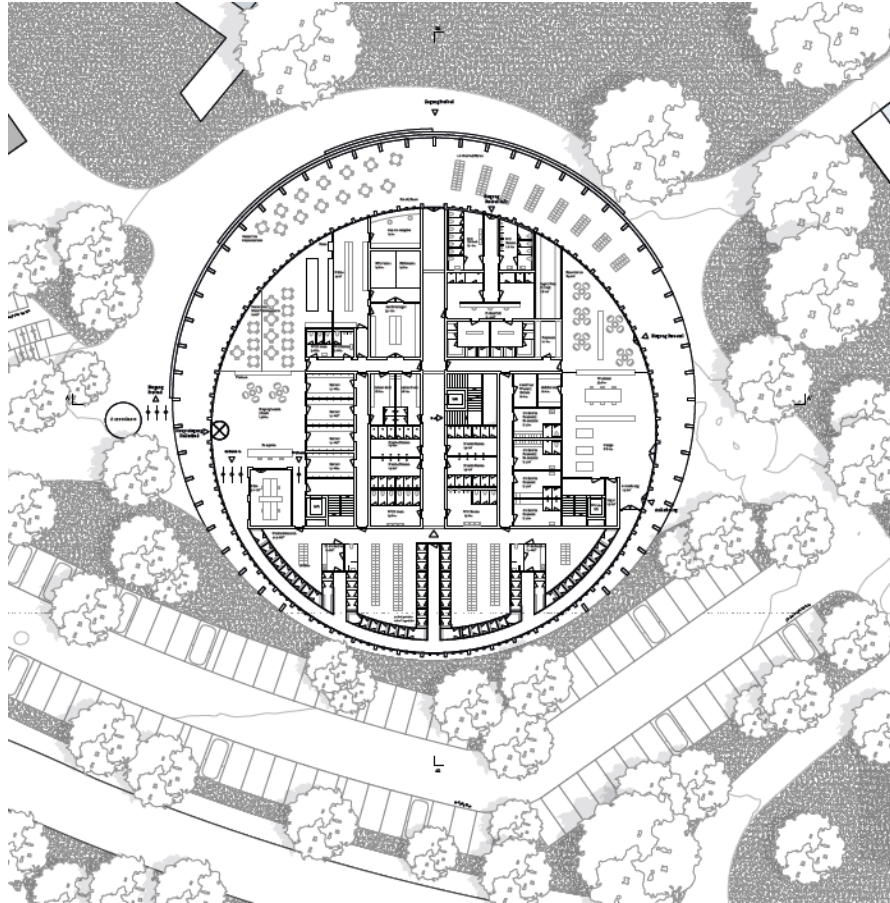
Grundriss Eingangsgeschoss (ohne Masstab)
